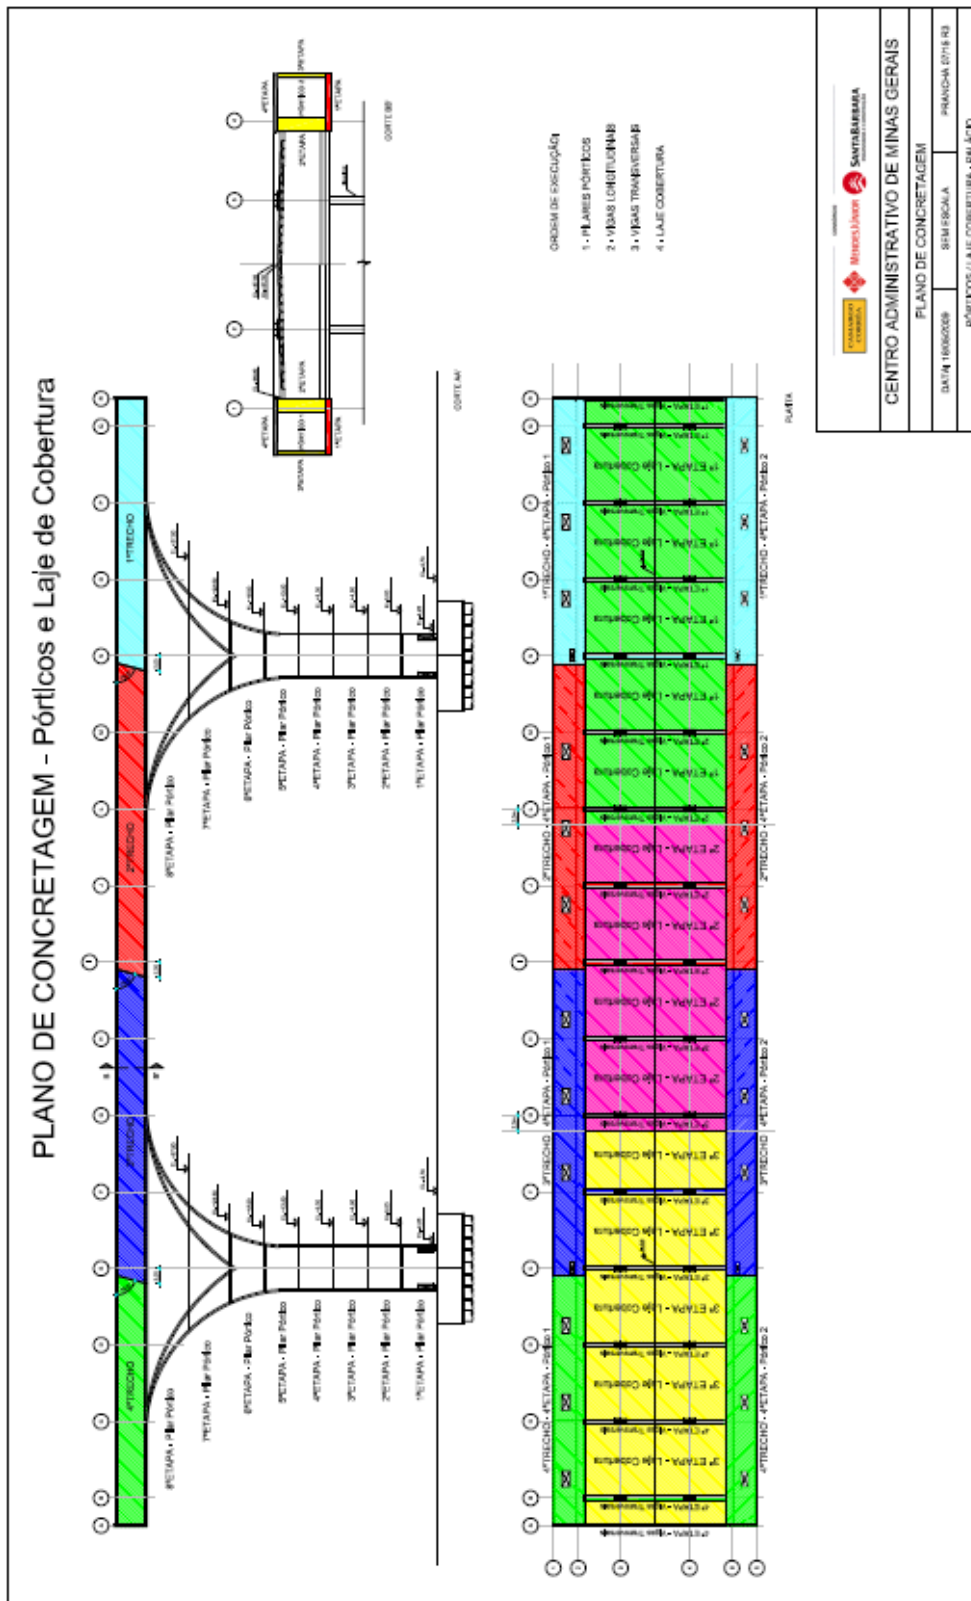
Plano de concretagem dos pórticos e cobertura
